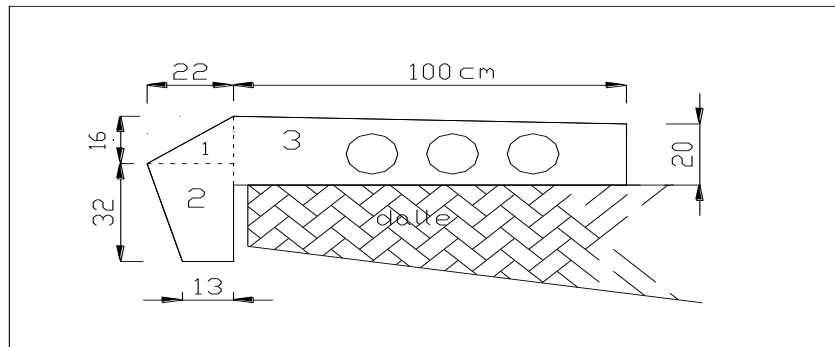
Coupe transversale du trottoir avec corniche.
